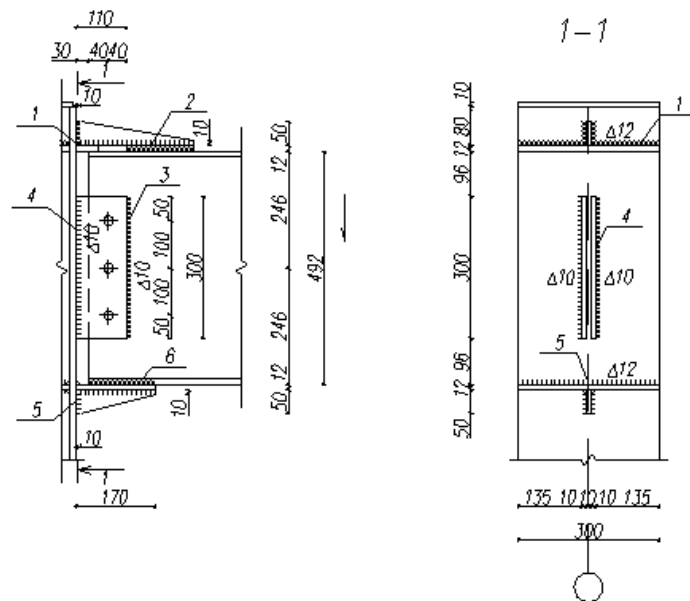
Схема кріплення ригеля до колони, вузол 4.
